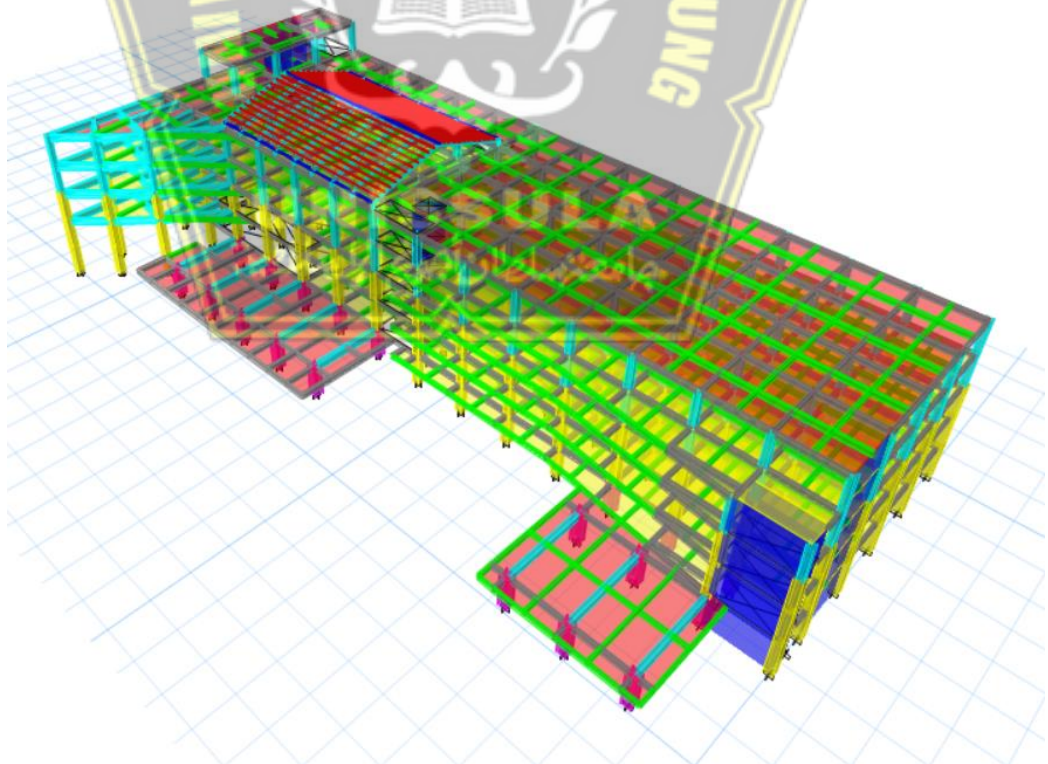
Penggambaran Plat Lantai Denah Lantai 2
